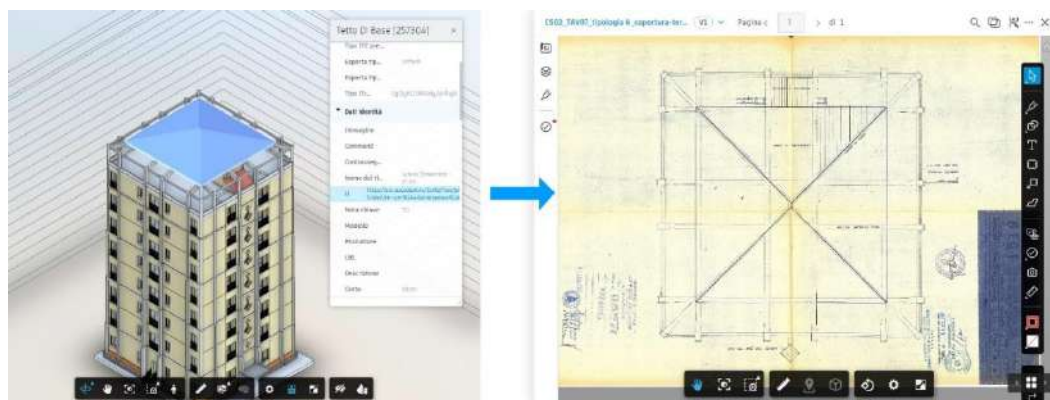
Ispezione di un elemento del modello e collegamento URL al documento d'archivio afferente.
